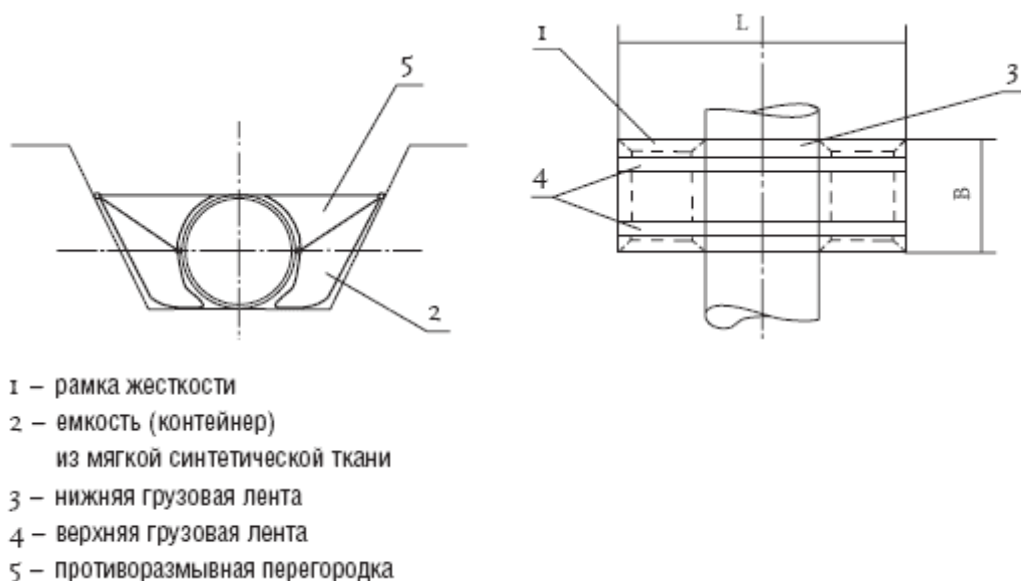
Схема конструкции полимерно-контейнерного балластирующего устройства
